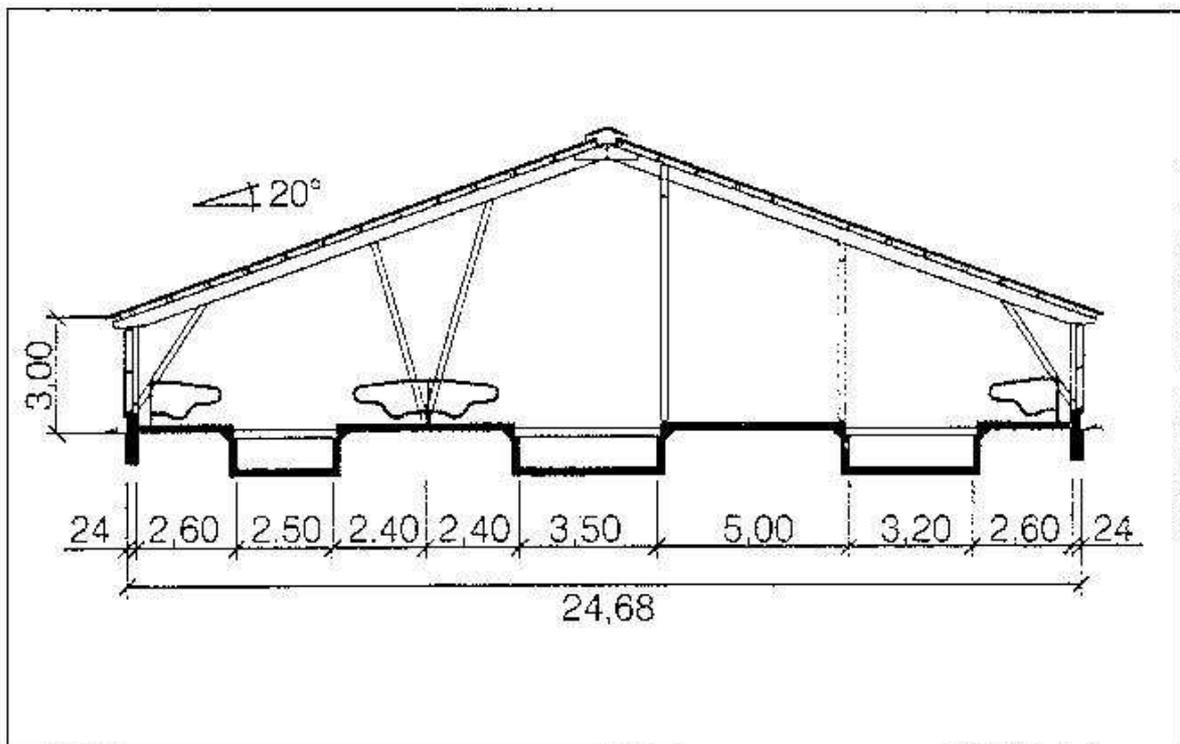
Stallgebäude (A. Conrads Holzbaubetrieb Werkbild)
